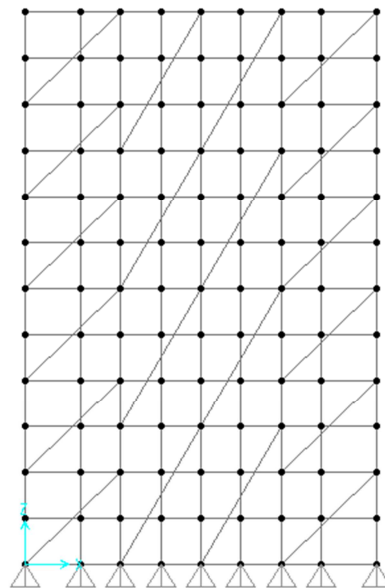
Configuração dos Planos de Contraventamento Vertical Com Elementos de Contraventamento Grandes
